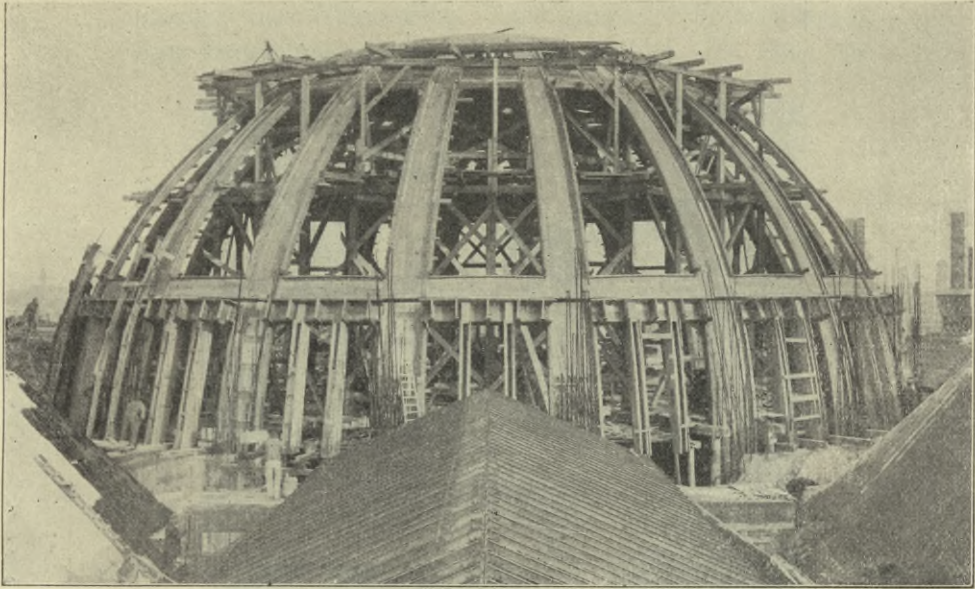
Friedrichstraßenpassage, Berlin. Rippenkuppel im Bau
